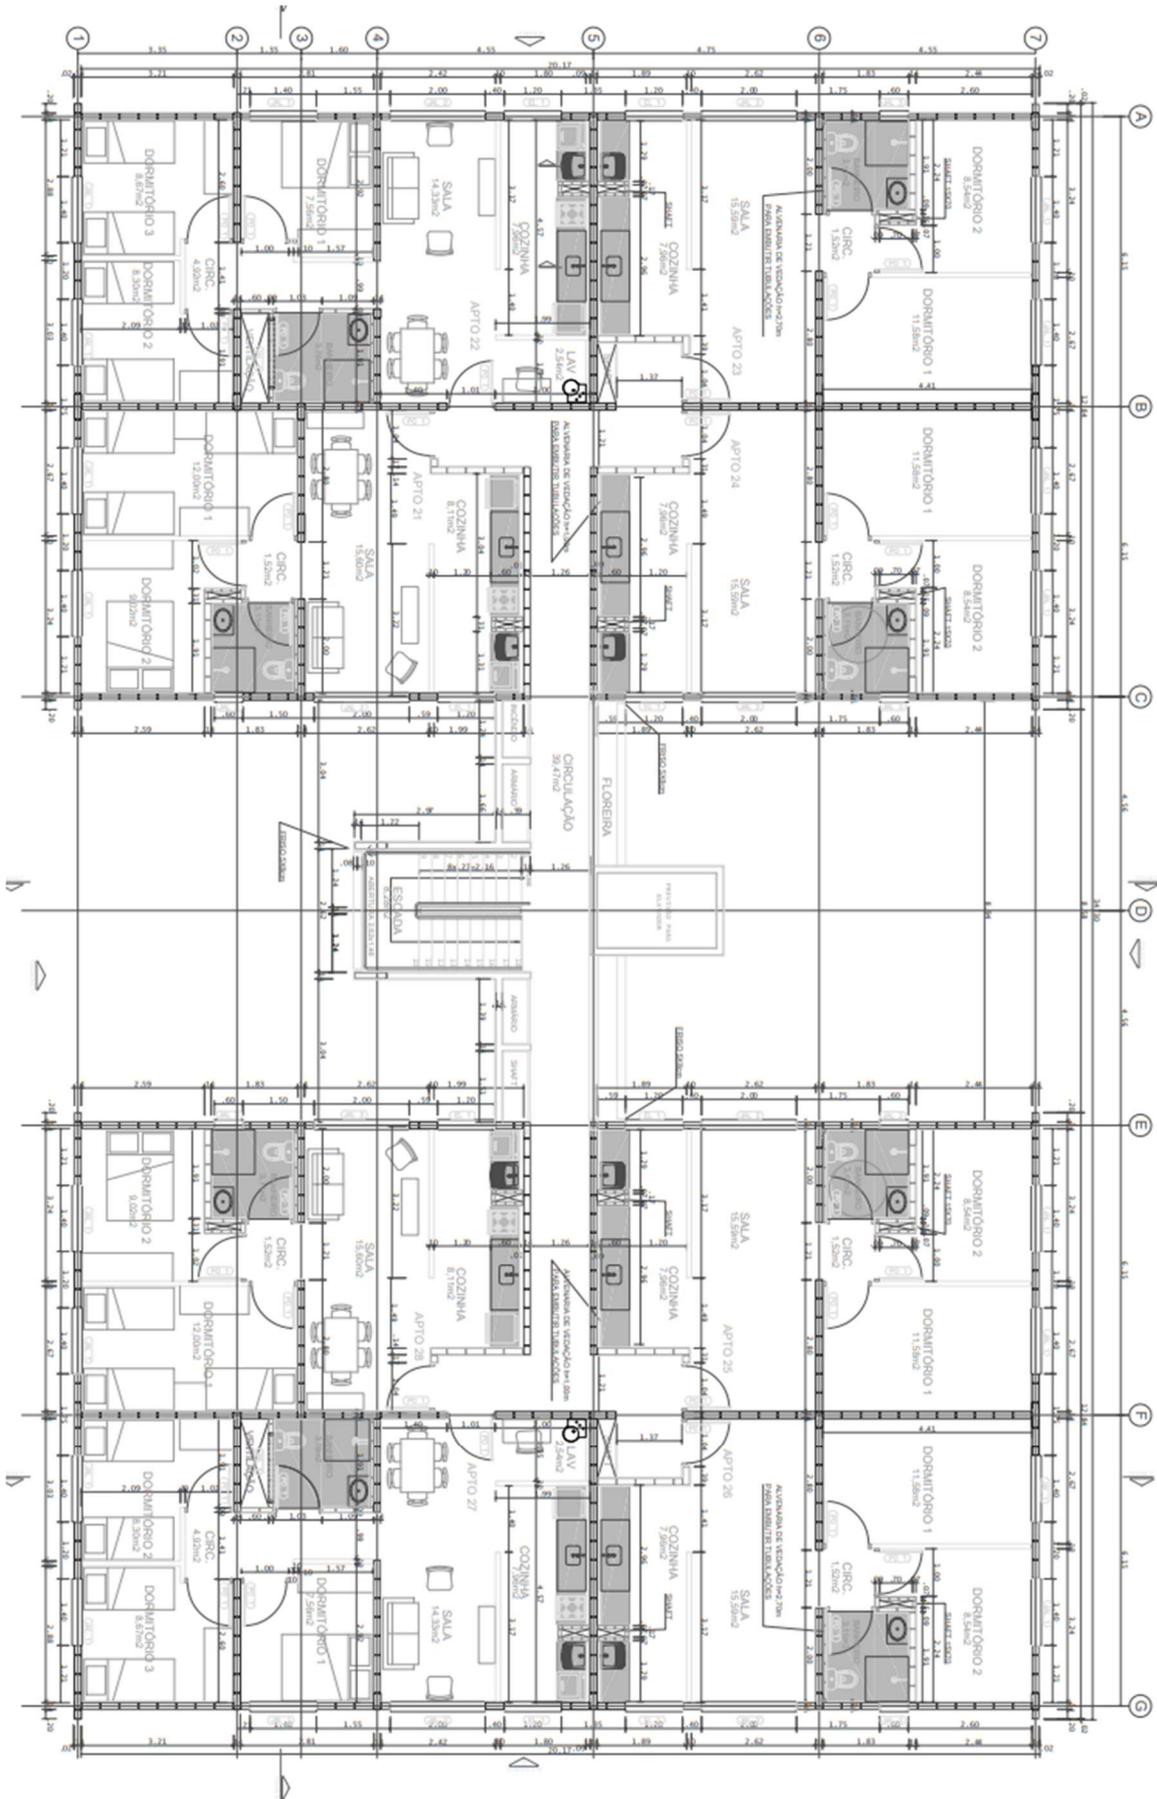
Planta do pavimento tipo - Fonte: projeto básico (2012)
